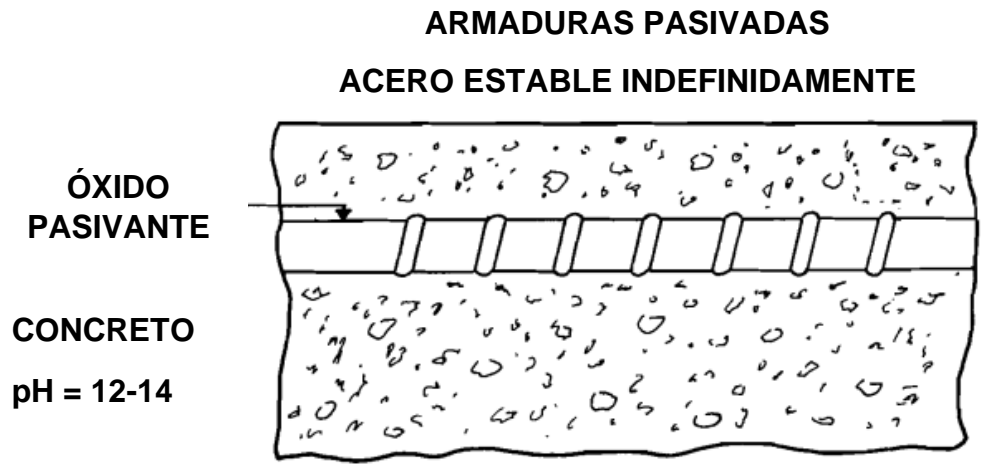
Armaduras embebidas en concreto sin contaminantes (Feliu, S; Andrade, 1989)
